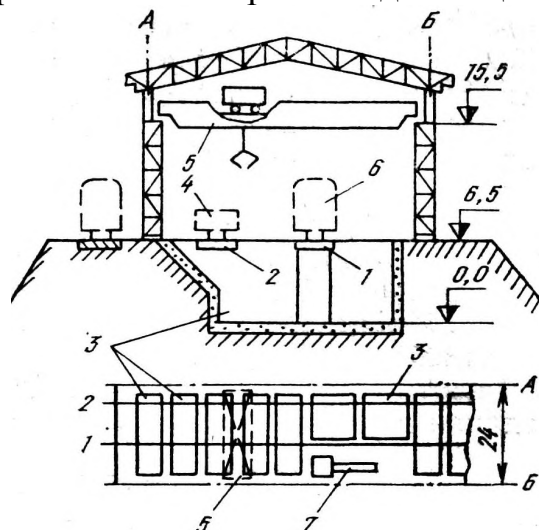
План и поперечный разрез верхнего ШО для сыпучих материалов
